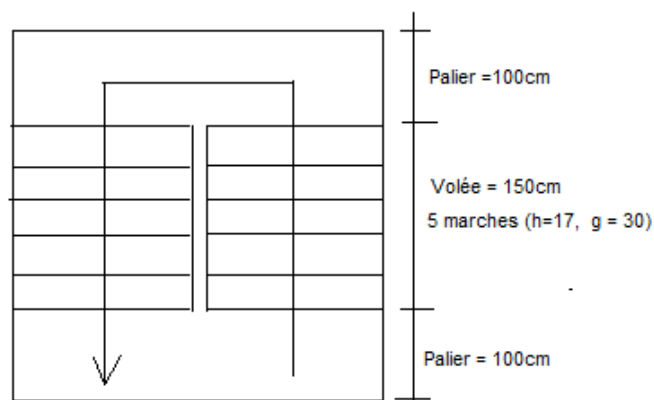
Dimensions en plan des escaliers à paillasse orthogonales.
